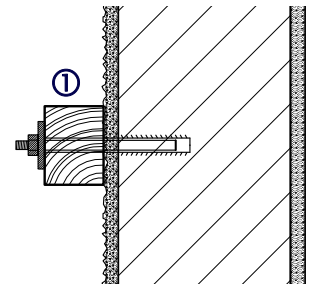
Erläuterungen zum Konstruktionsaufbau (Vertikalschnitte)
